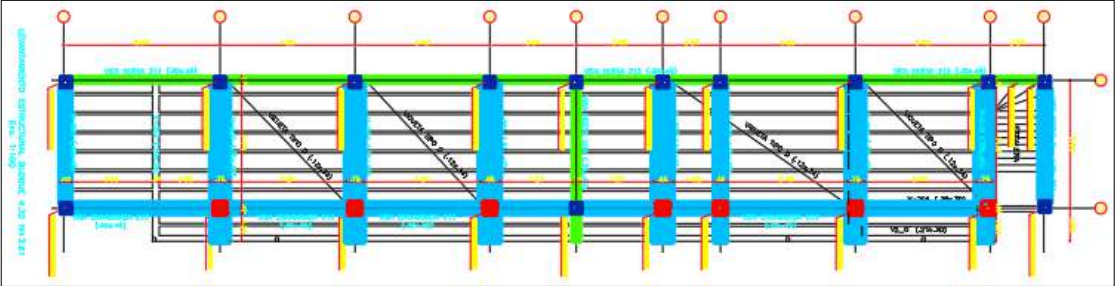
Esquema de distribución de Columnas Encamisadas (Rojas), columnas nuevas (azules) y vigas encamisadas (cyan) en la placa existente de 2do piso
